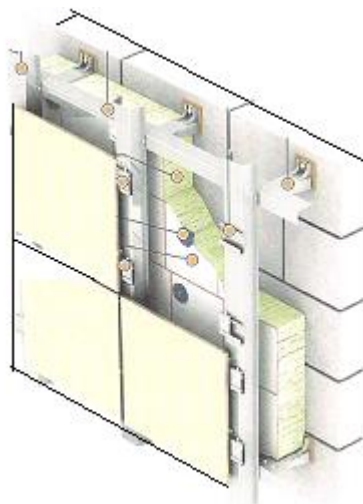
Вариант скрытого крепления облицовочных панелей
